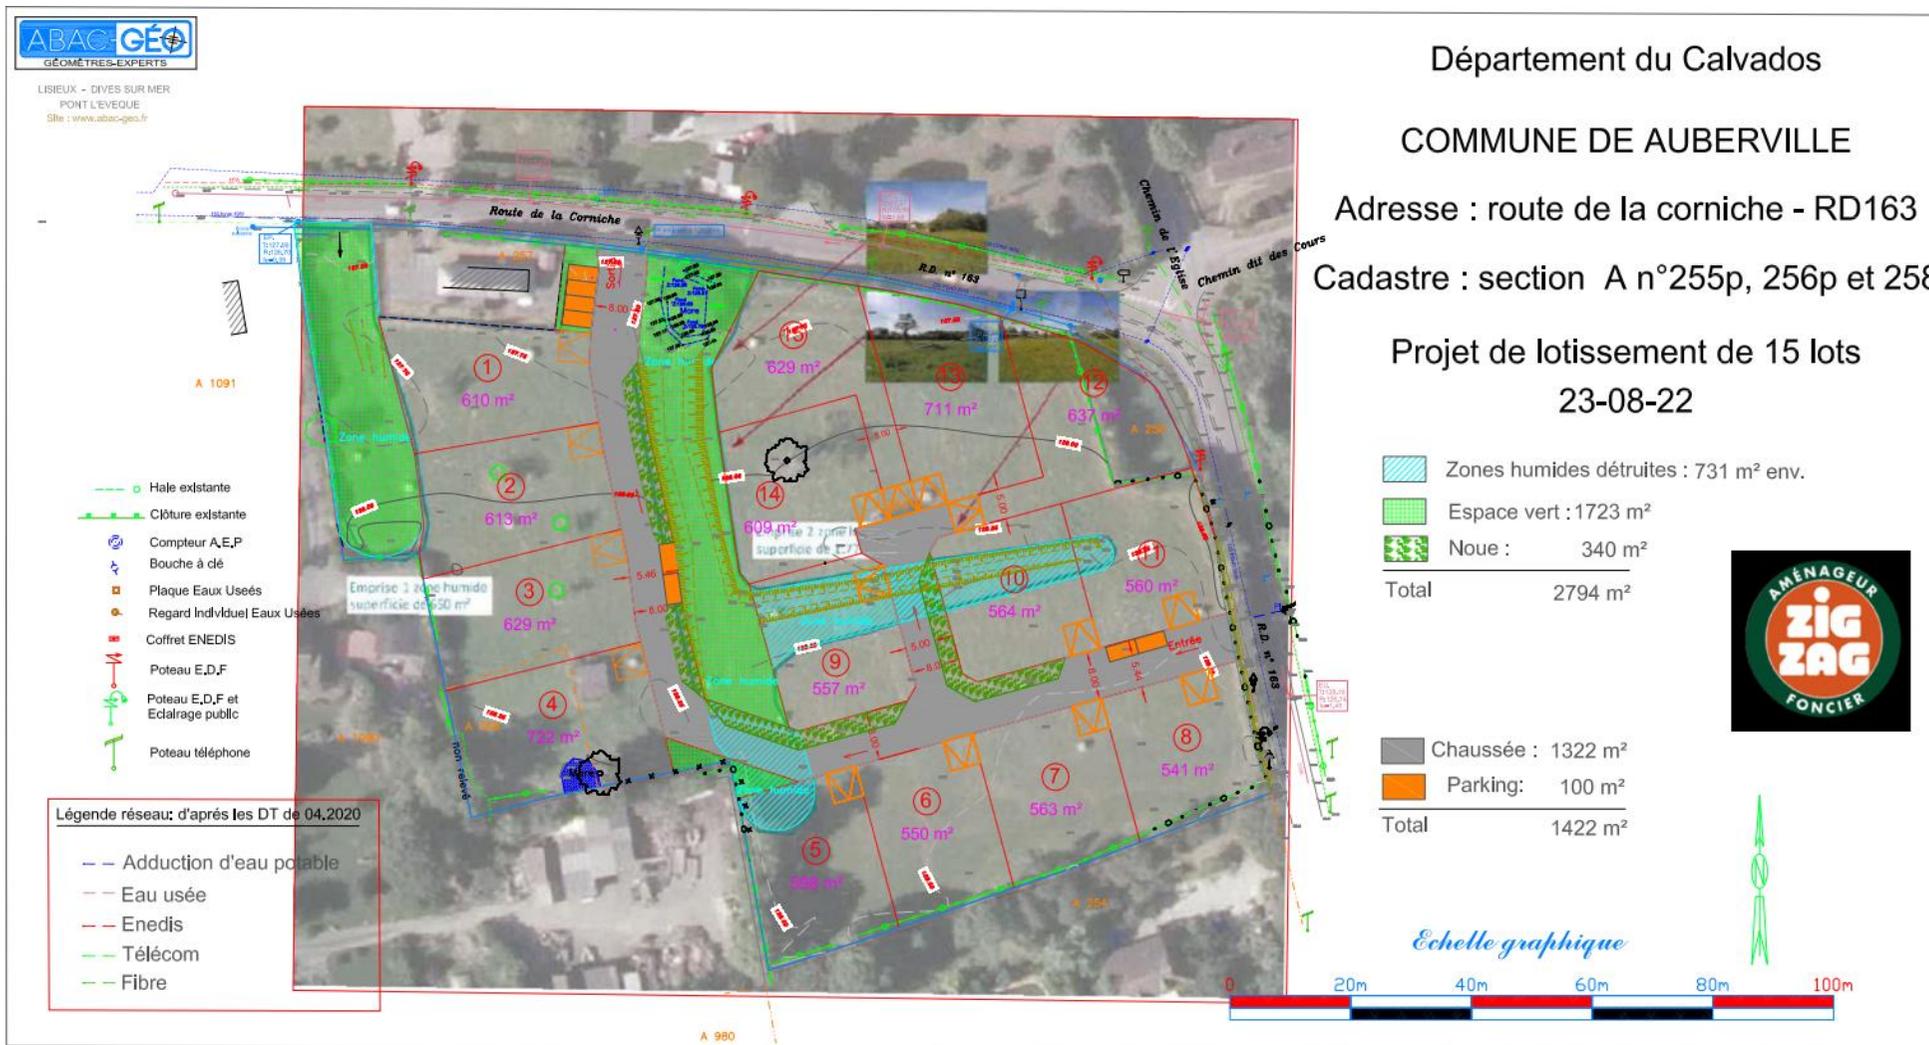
Plan d'aménagement du projet d'aménagement sur le secteur d'étude
